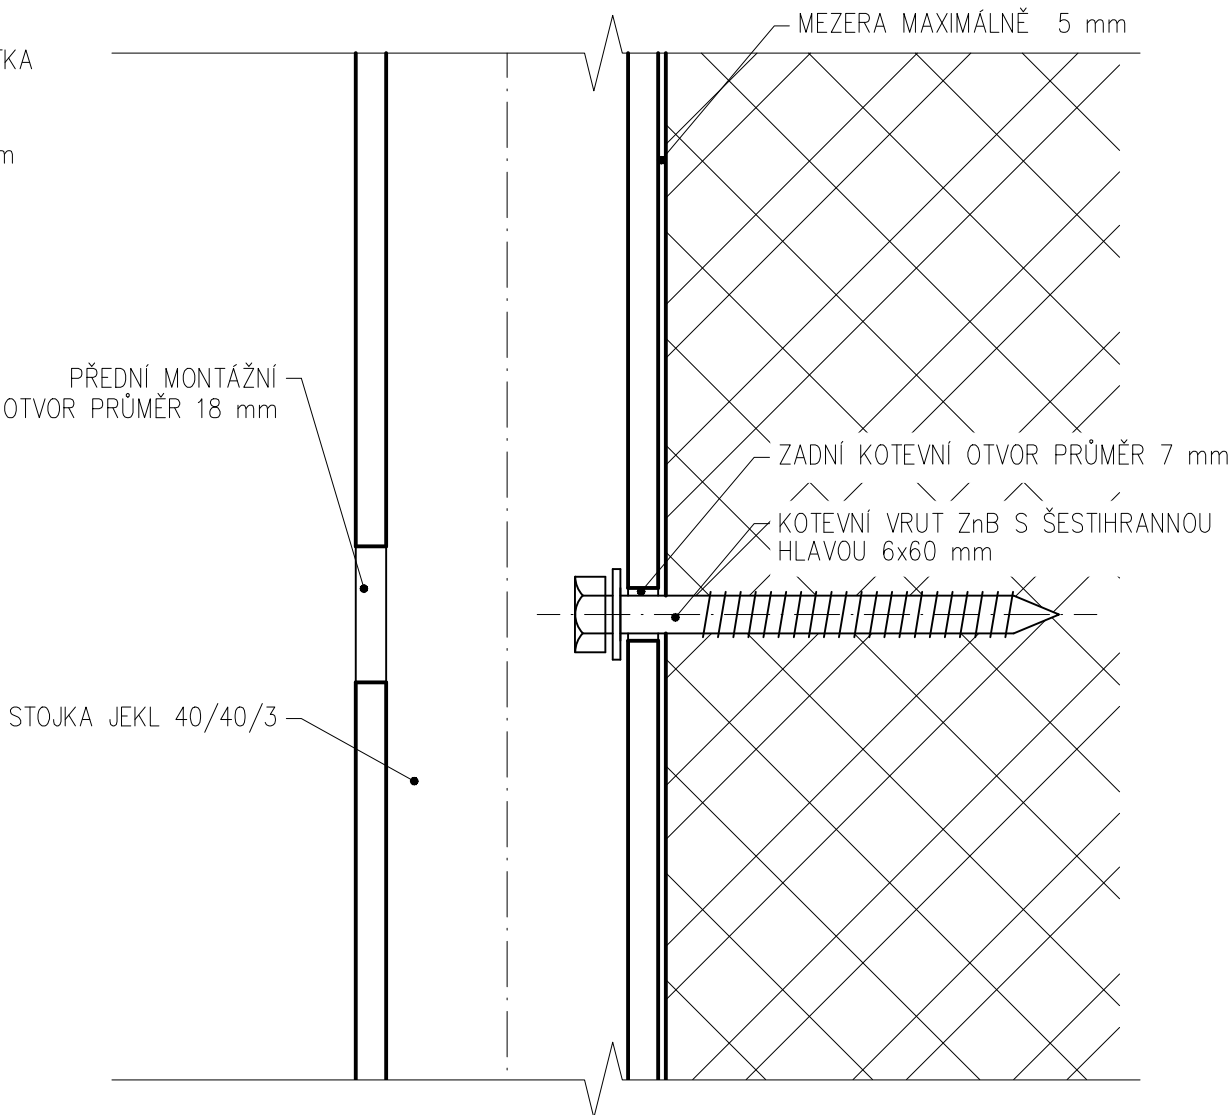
KOTVENÍ C-PROFILU K HORNÍ PŘÍČLI - ŘEZ 1:1
